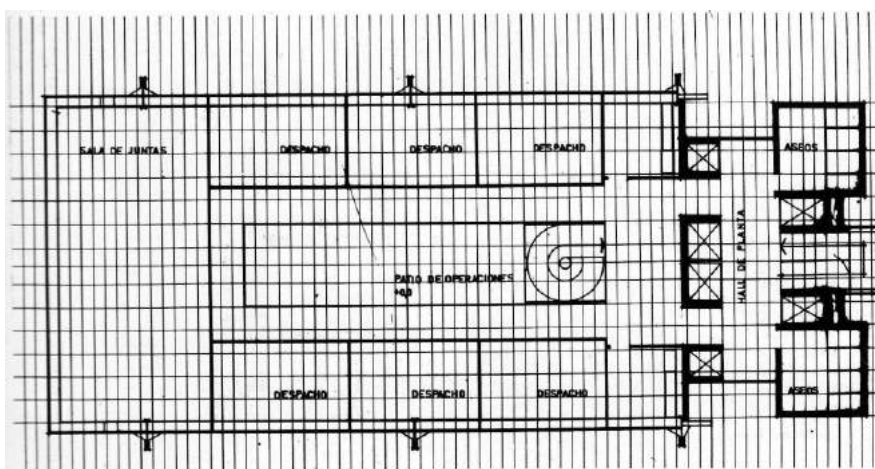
Curro Inza. Edificio Bankuni. Planta de la propuesta de Curro Inza. 1969. Revista Arquitectura n144, 1970. p 24.
